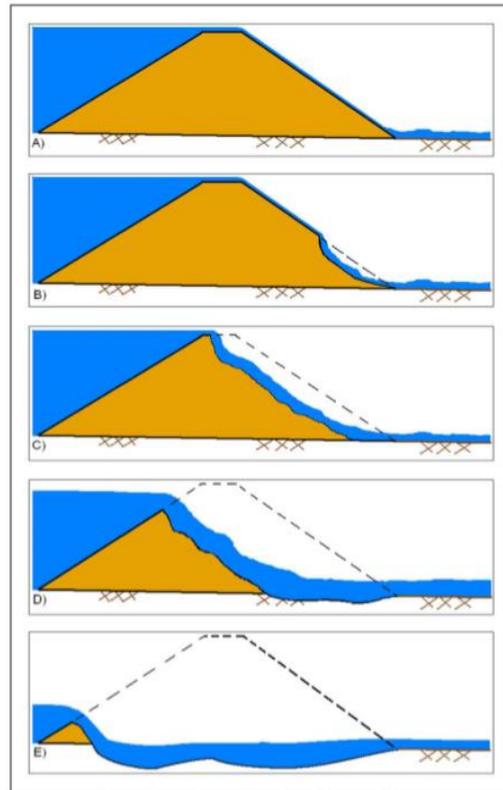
Mekanisme Keruntuhan Akibat Piping (Hydrologic Engineering Center, 2014)
